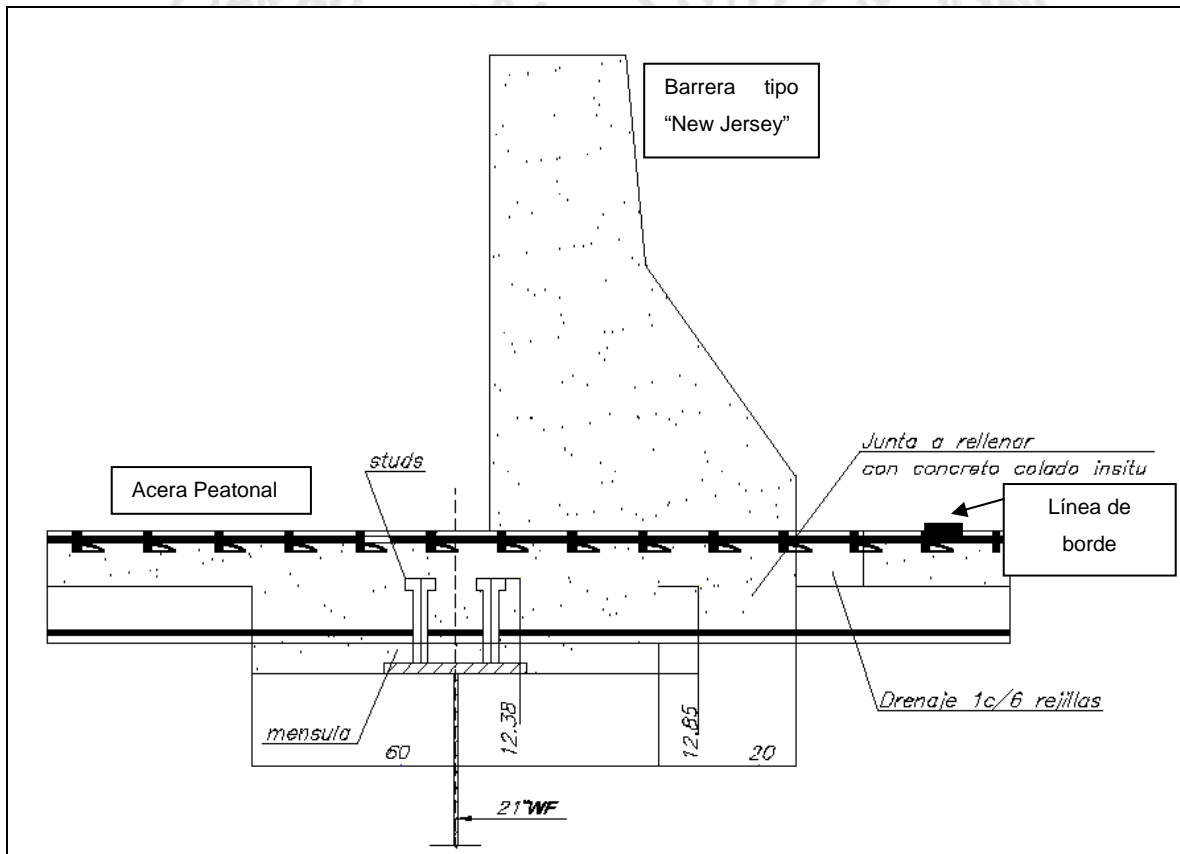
Detalle de los drenajes en planos. Corte transversal al sentido de circulación.
